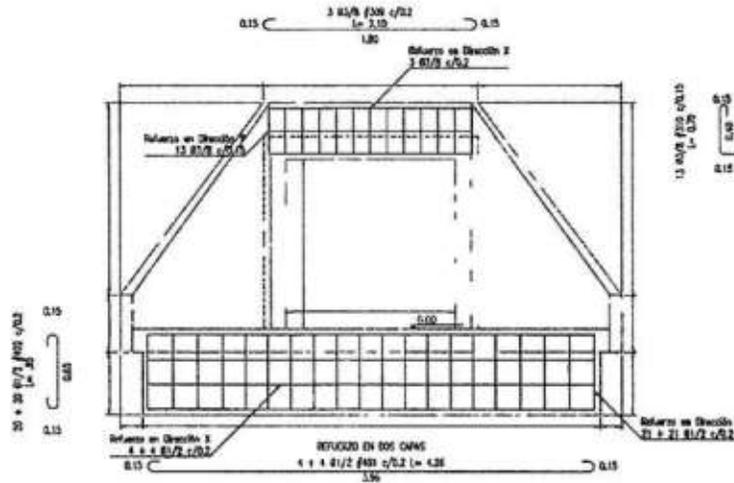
Planta Vista frontal y refuerzo del cabezal del box culvert de 1.50x1.50m del Tramo vial San José de Oriente – El Rincón.
